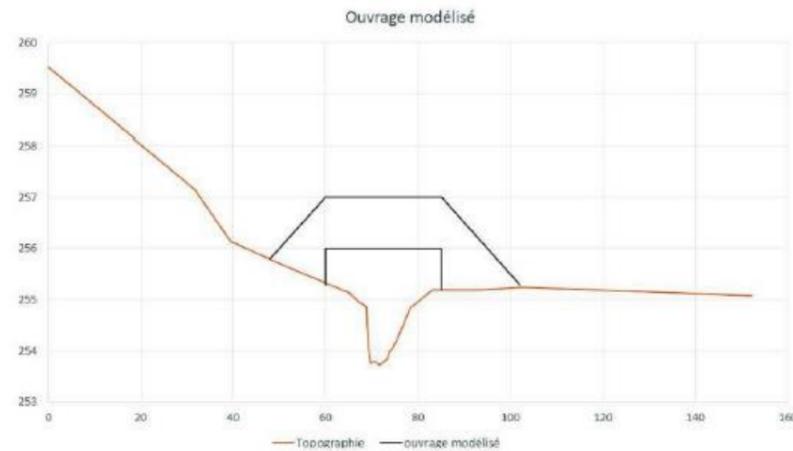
Profil de l'ouvrage de franchissement au niveau du profil 6 de pk 1707
